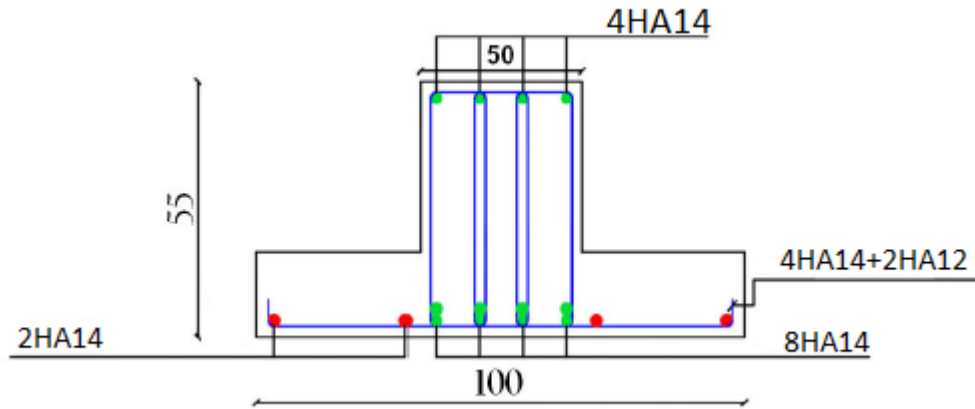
ferrailage de la semelle filante par autocad 2012.
